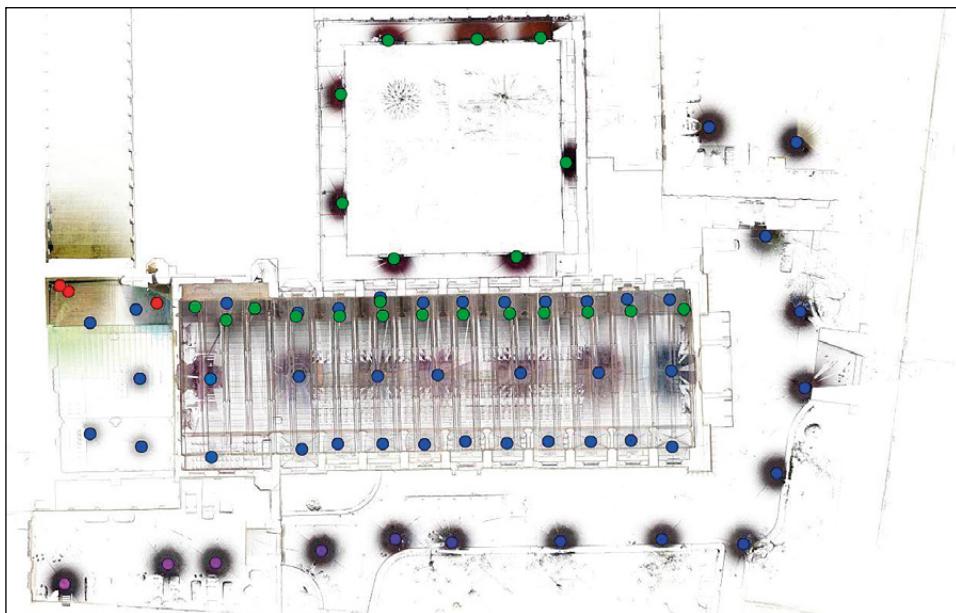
Indicazione planimetrica delle stazioni laser.
